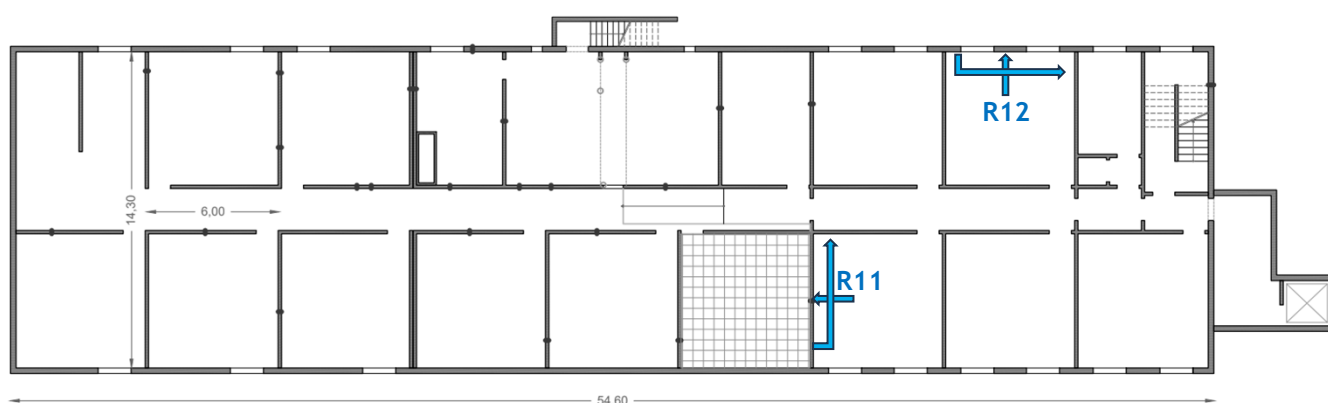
Bâti 14 - Plan de principe du sous-sol localisant les radars réalisés (sur voiles en bleu et plancher bas en vert) - sources : relevés in situ et plan transmis par l'académie de Créteil - Unités en m
